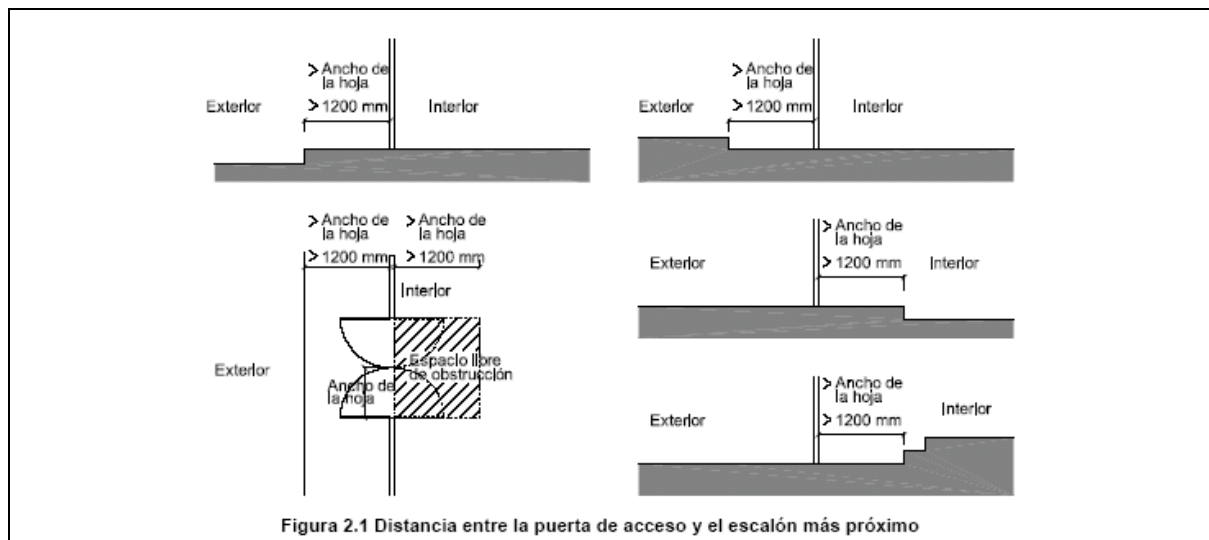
Distancia entre la puerta de acceso y el escalón más próximo
